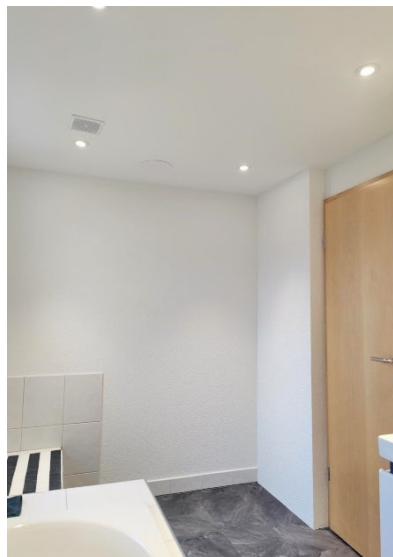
Abgehängte Decke nach dem Einbau mit Abluft und integrierter Beleuchtung
